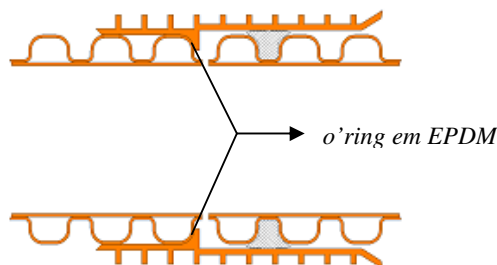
Pormenor de ligação entre tubos de PP corrugado (em corte)
